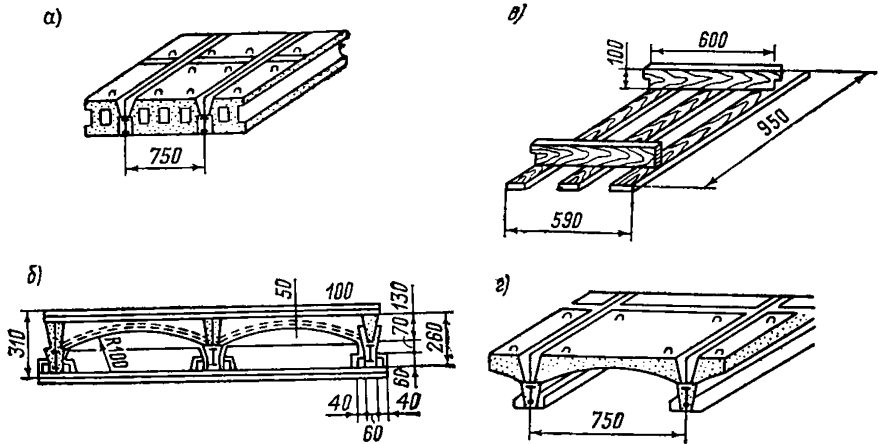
Сборно-моноконтное перекрытие Лаптера
